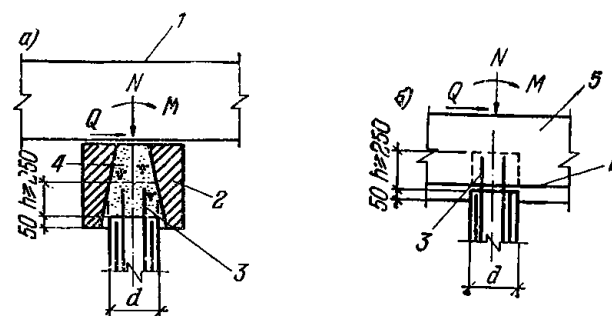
Примеры конструктивного решения сопряжений железобетонных свай с ненапрягаемой и преднапряженной арматурой, работающих на вертикальные сжимающие и поперечные усилия и моменты, а также на внецентренные сжимающие нагрузки, выходящие за пределы ядра сечения свай, с ростверком
